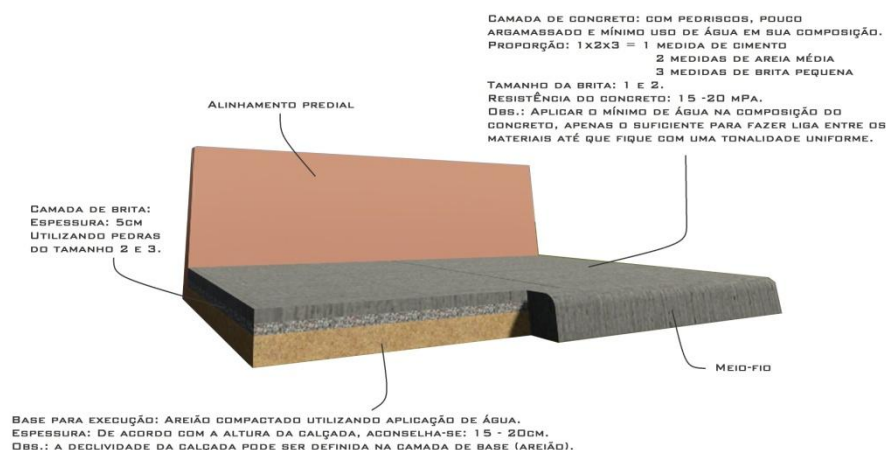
Tutorial de execução para calçada utilizando o material “cimentado”
